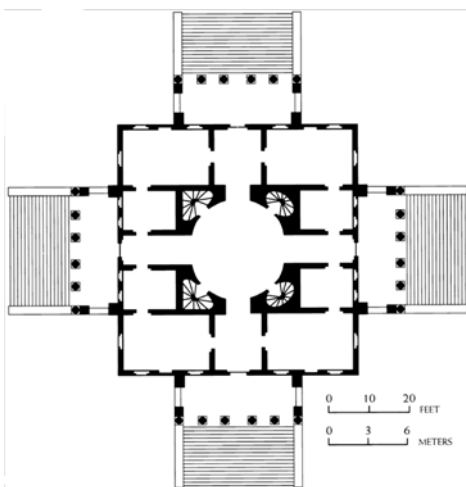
Planta de La Rotonda en Villa Capra (1566).
